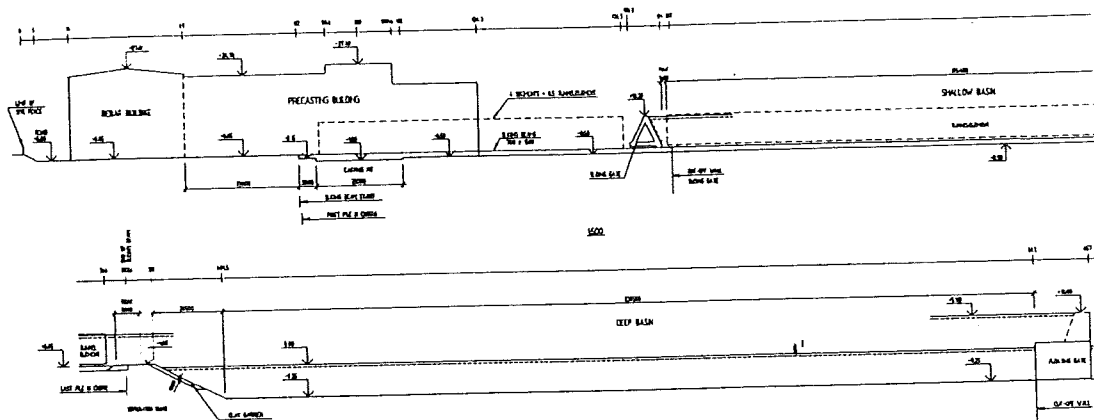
, Plattegrond elementenfabriek Øresundtunnel
